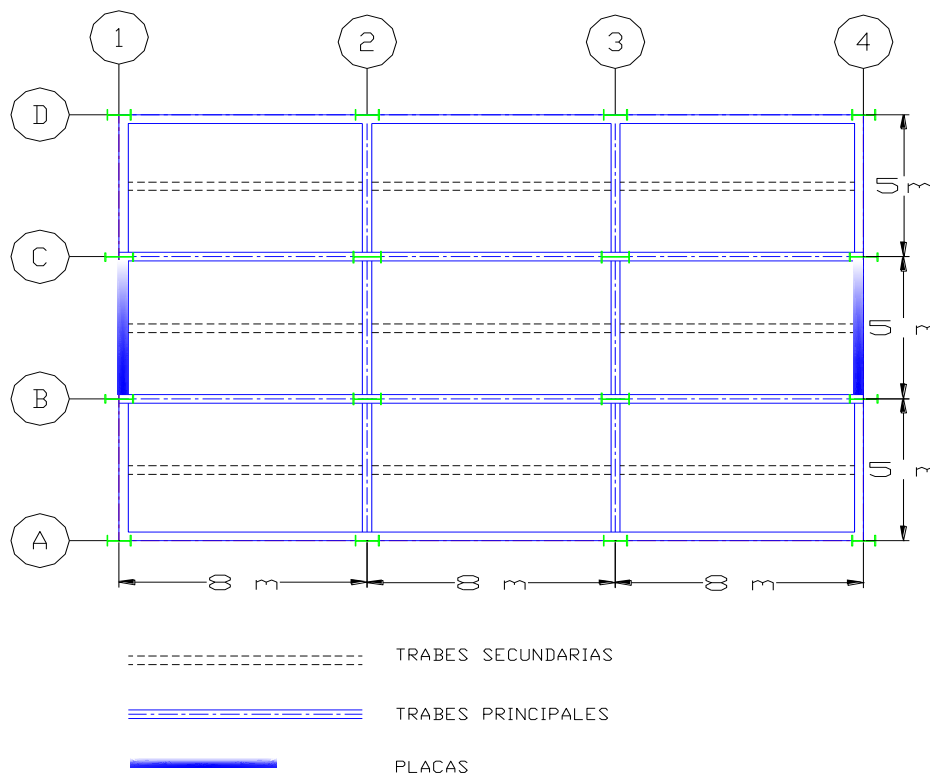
Planta del edificio modelado (dibujo acotado en metros y sin escala).
